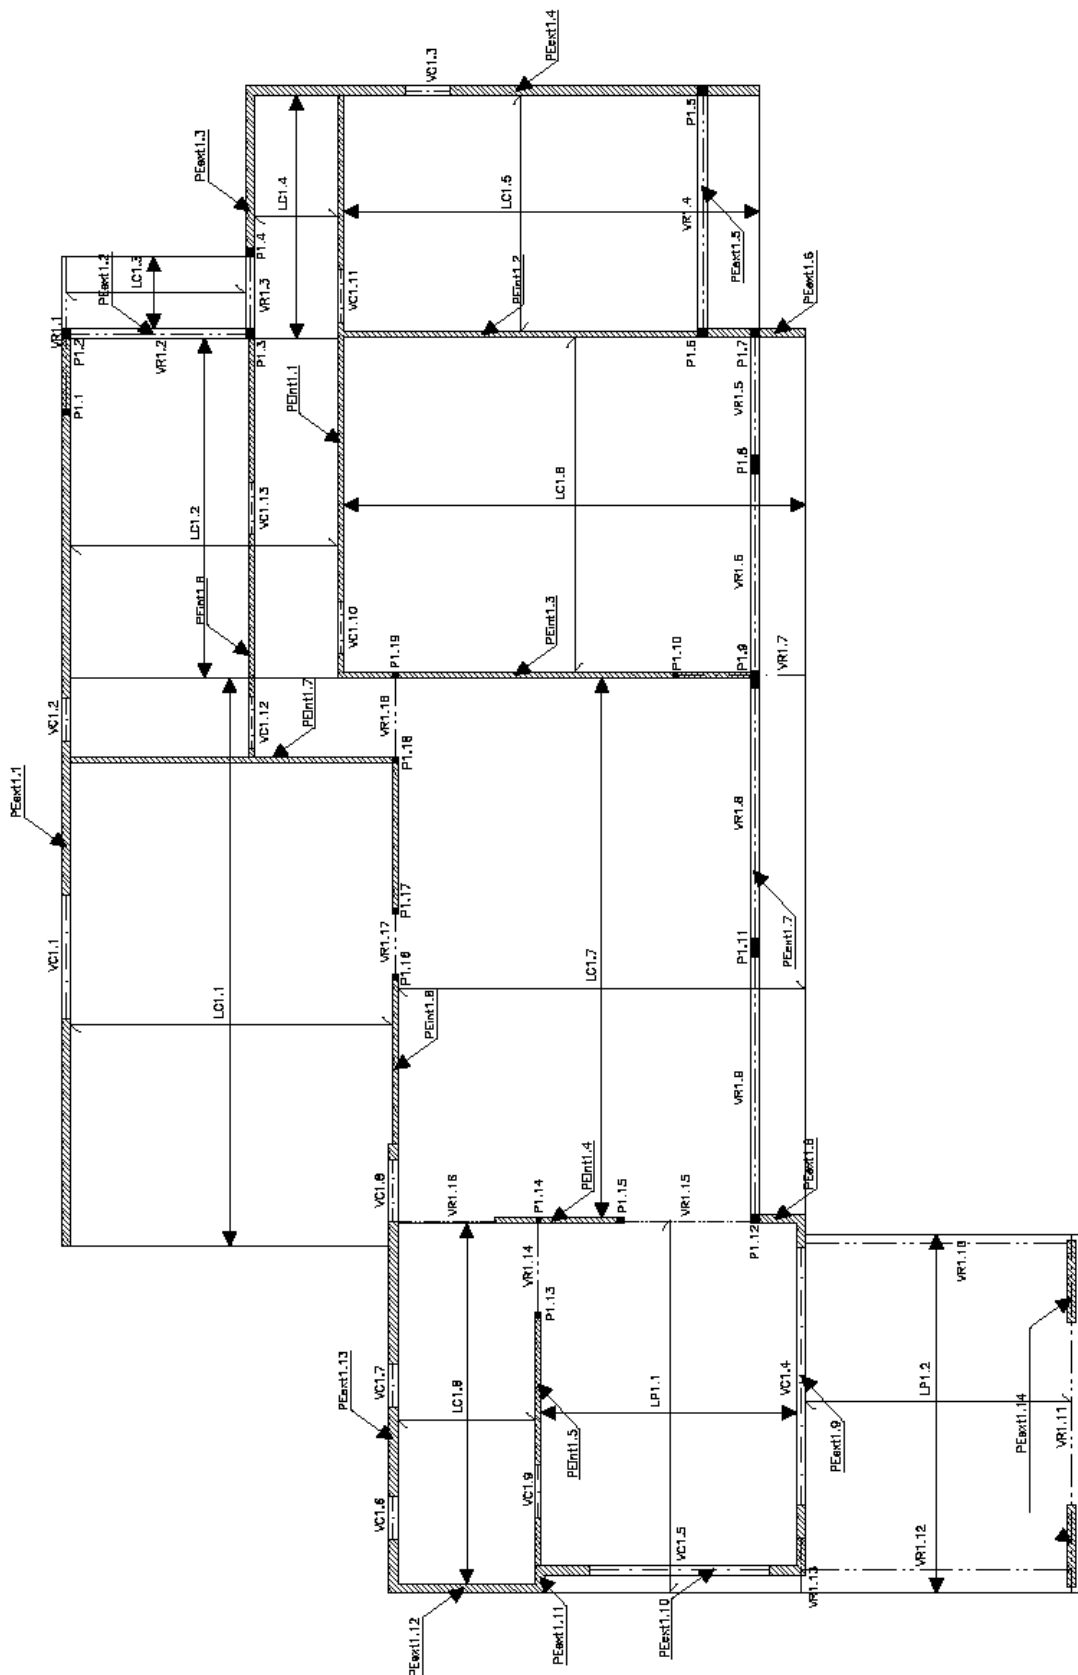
Planta do rés-do-chão das lajes de pavimento (LP), lajes de cobertura (LC), vigas de reforço (VR) e vergas (vigas de cabeceira - VC).
